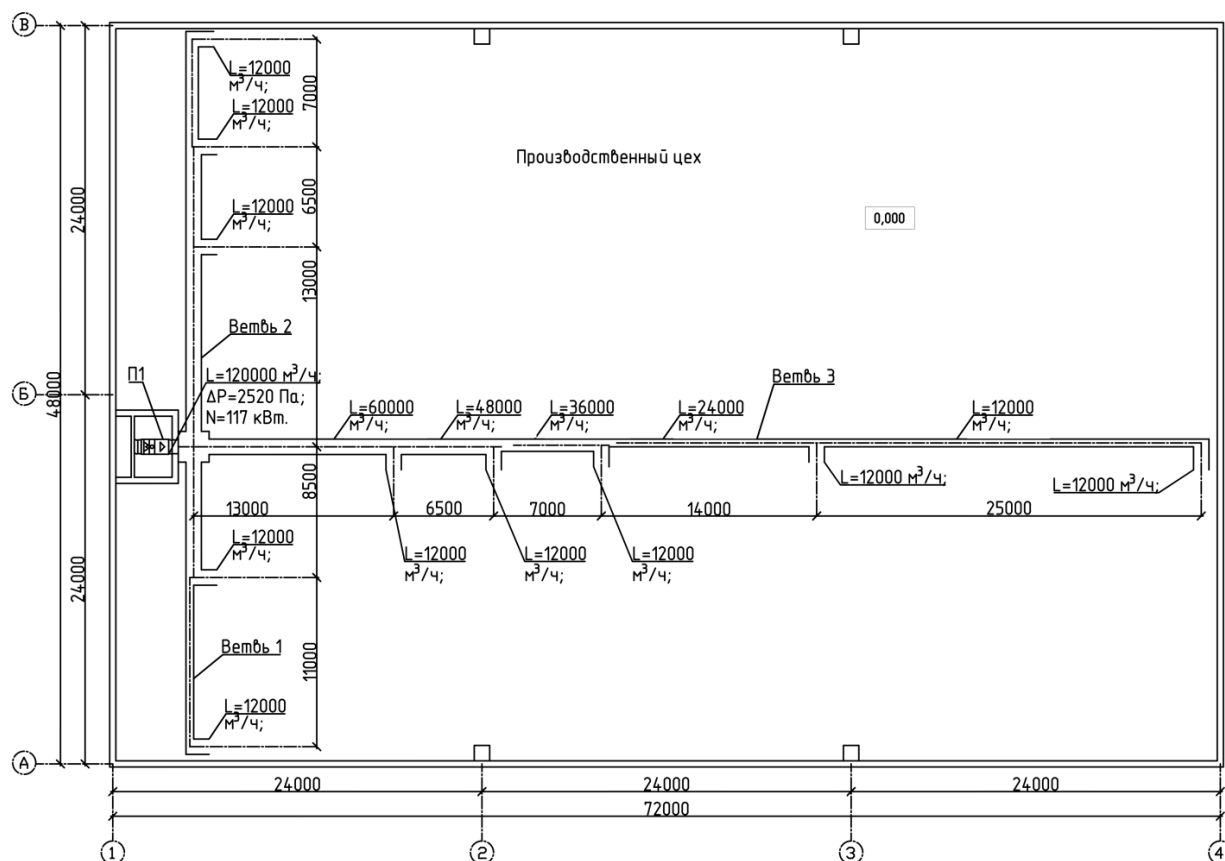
План воздуховодов вентиляционной сети с одним центральным вентилятором
